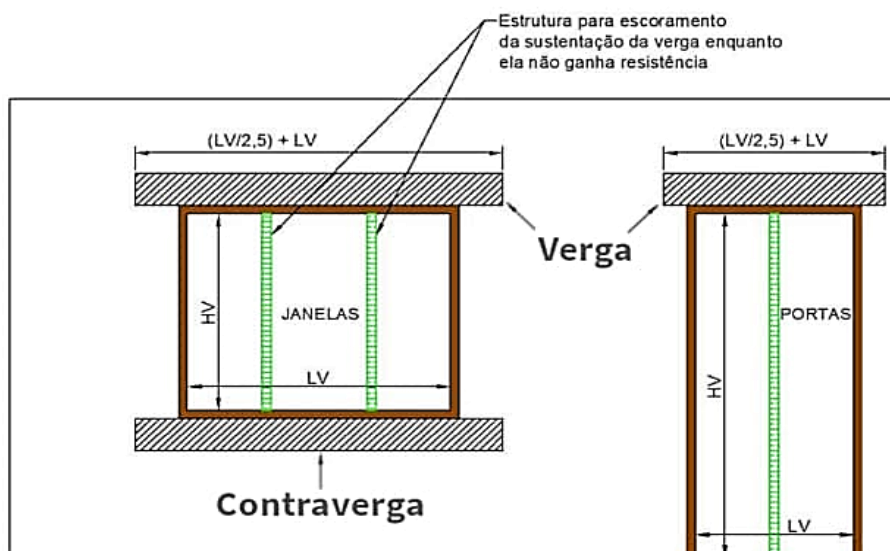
Cálculo de comprimento de Vergas e Contravergas
